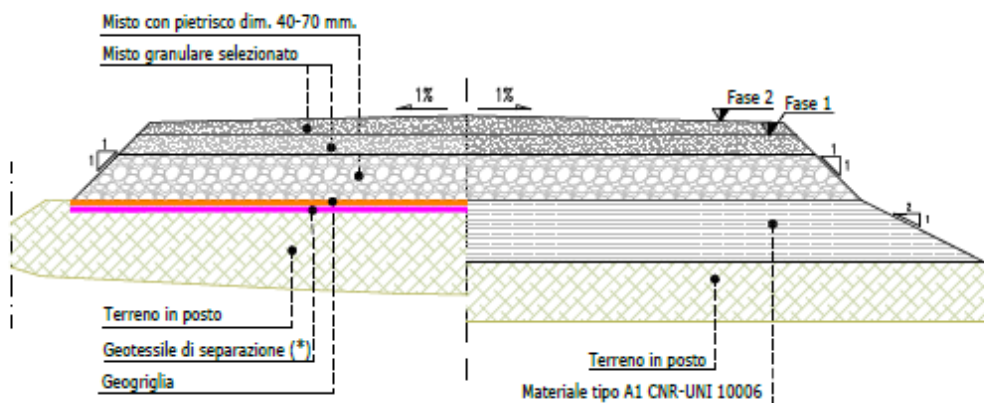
Sezione stradale tratti in rilevati ($p < 13\%$)
